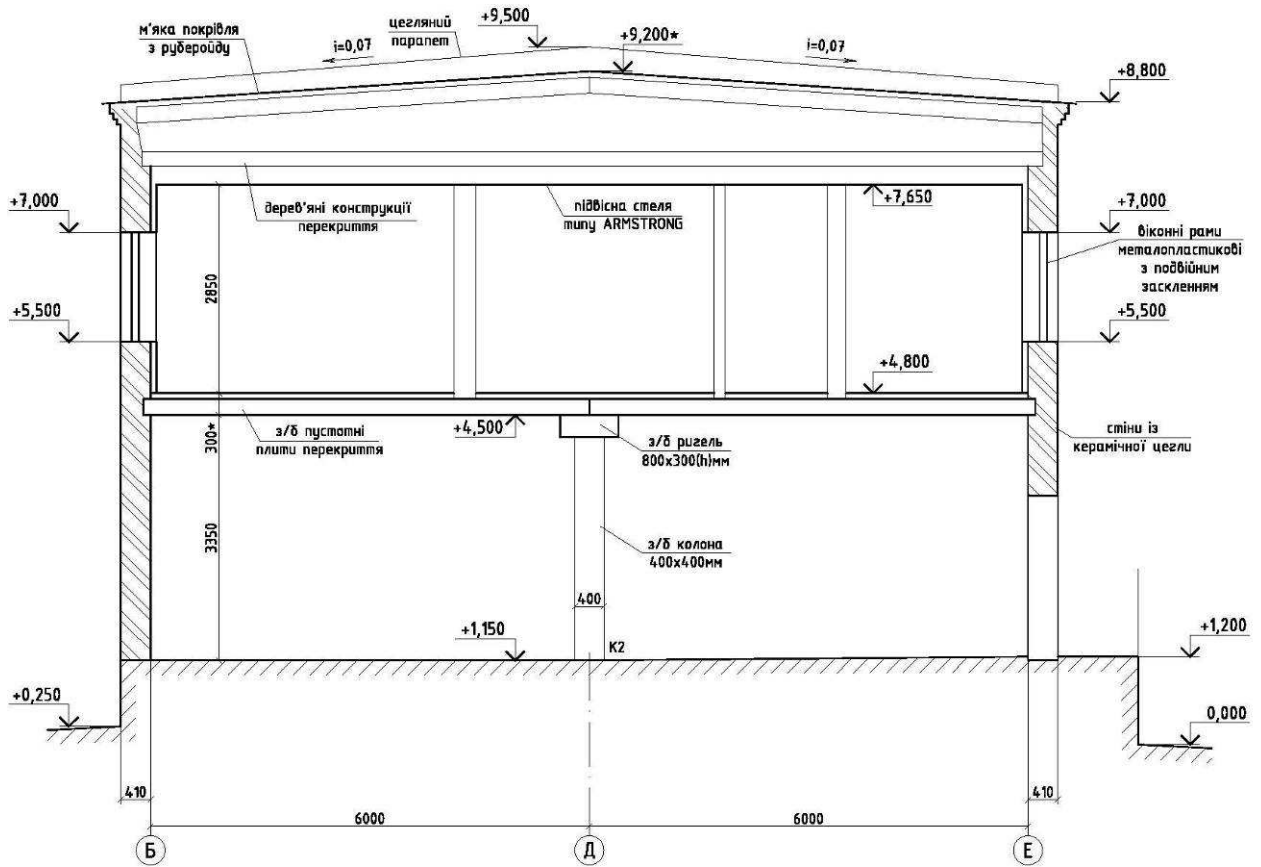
Поперечний розріз 1-1 між осями 1-4 будівлі цеху фасування, складу тари
